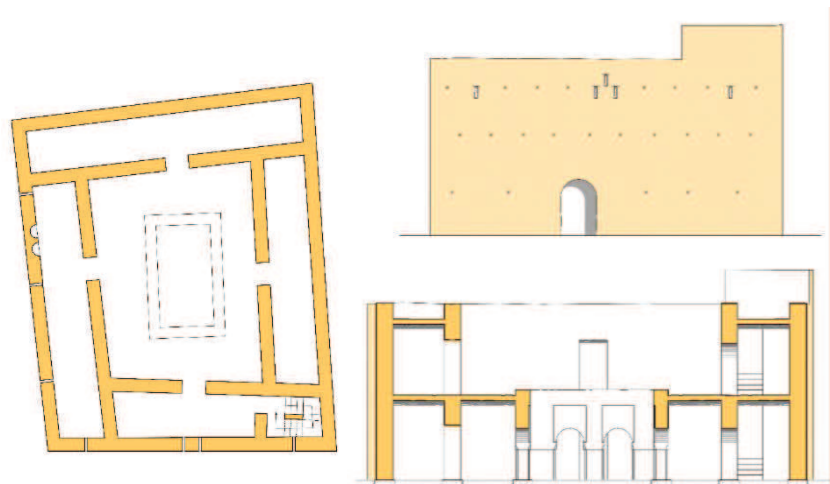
Vue en plan, façade et coupe de Dyariyyet Ahl Essanhouri, (échelle : 1/200).
